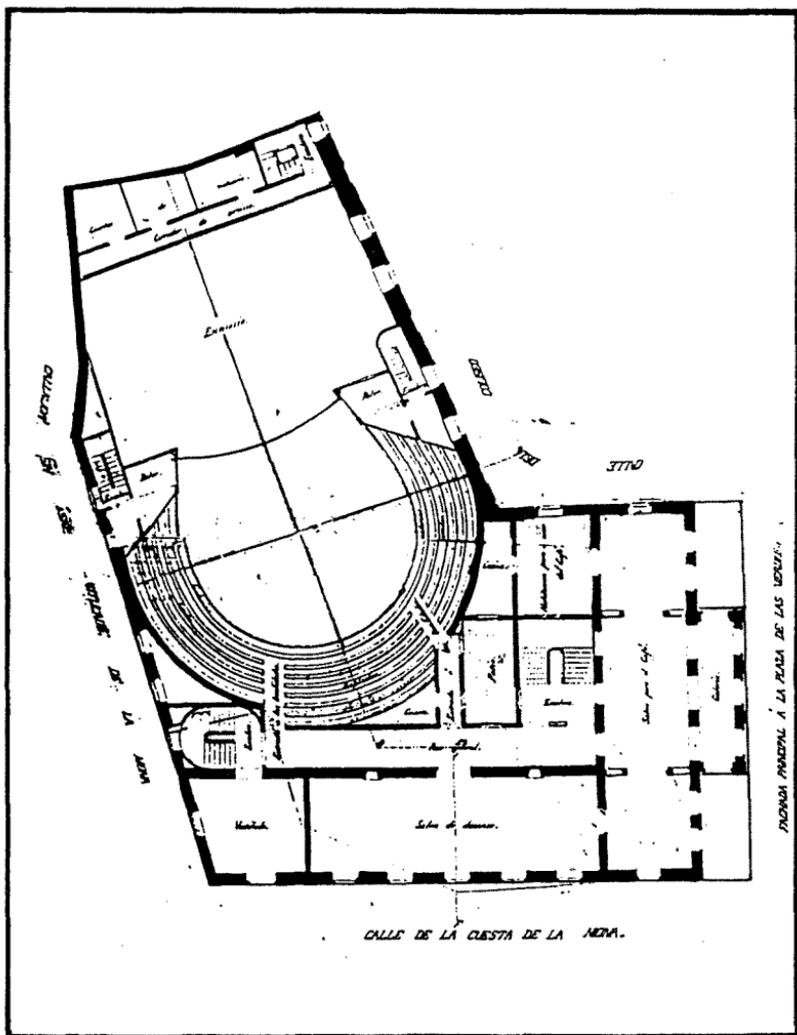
Proyecto de Fenech de 1866. Pisos y galerías superiores (A.M.T.).
